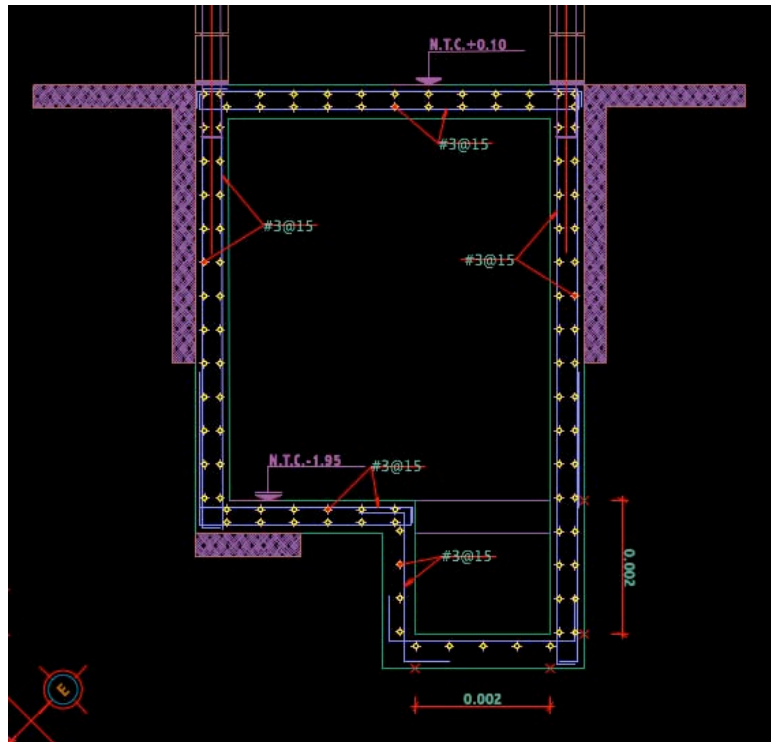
Armado de cimentación de la cisterna (corte 19-19)
